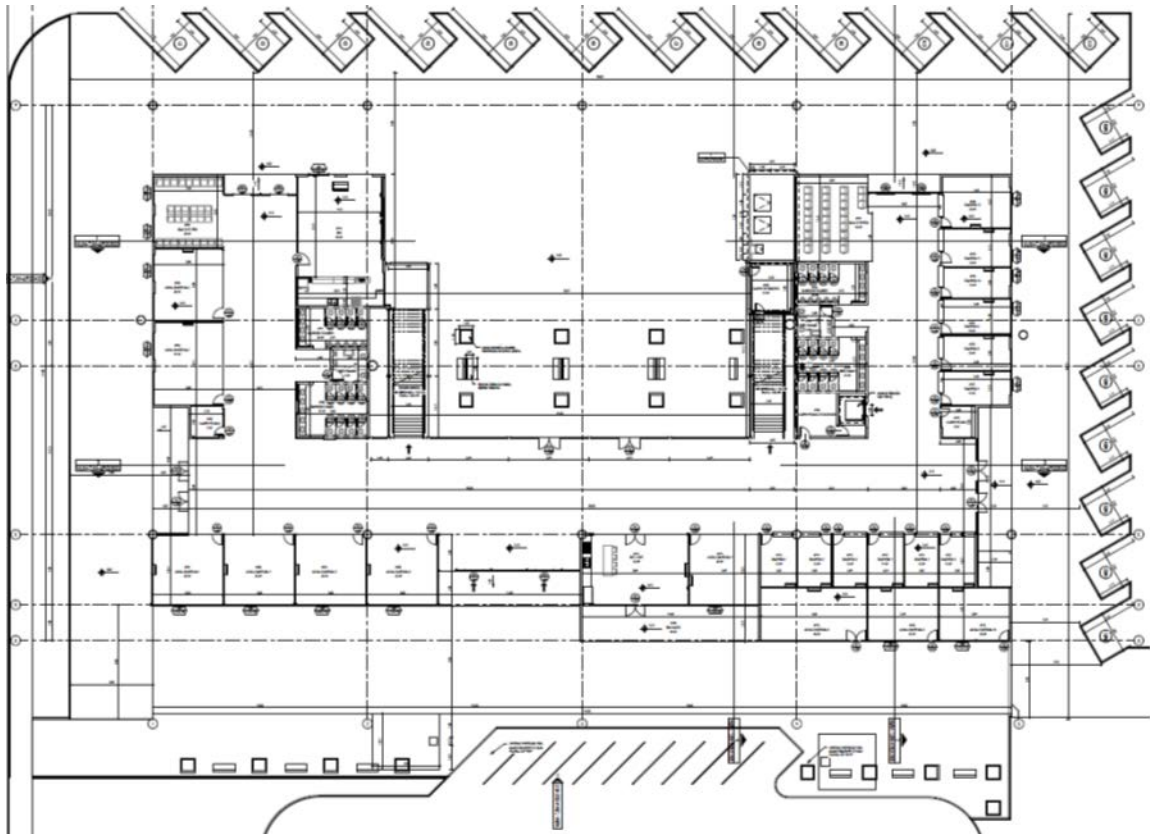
Planta baja nueva terminal de ómnibus Jesús María
